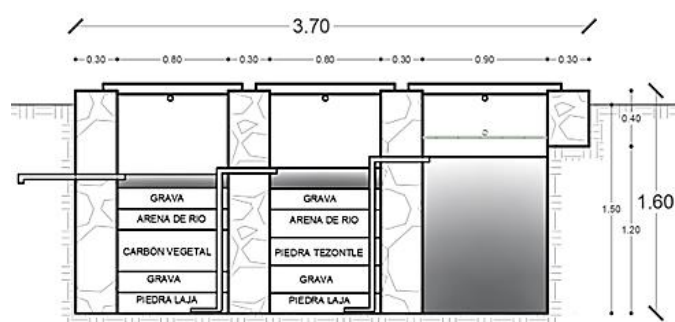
Dimensionamiento de captadores de filtros de agua gris: Fuente: Elaboración propia.
